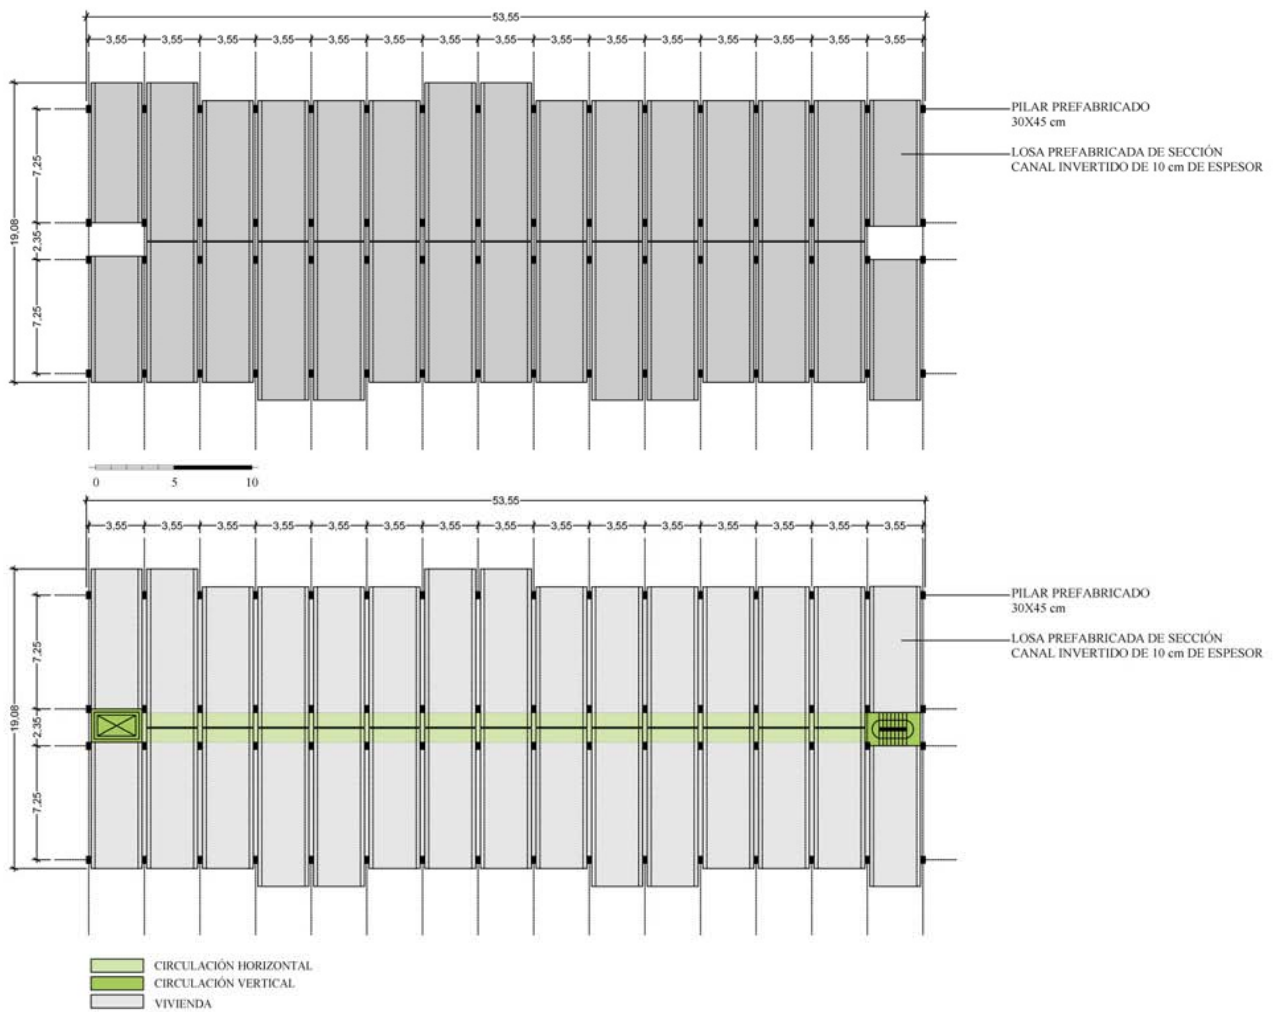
Plantas esquemáticas: constructiva y de distribución
